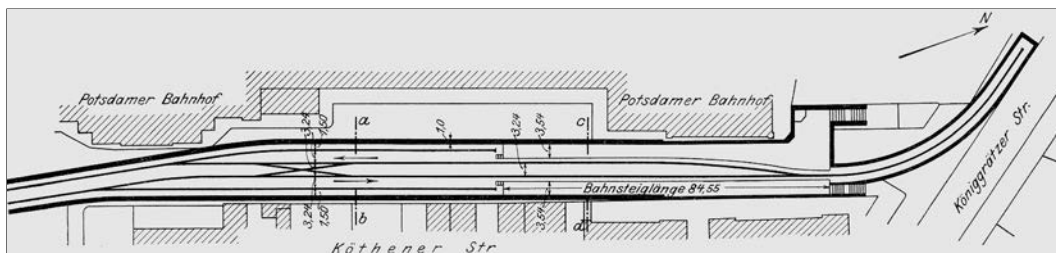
Lageplan des ersten Untergrundbahnöfs Potsdamer Platz neben dem Potsdamer Bahnöf (Sammlung Axel Mauruszat)
